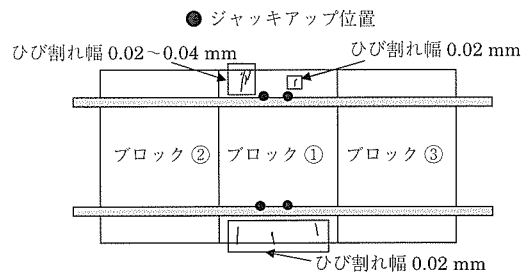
床版下面部におけるジャッキアップ後のひび割れ概要図
